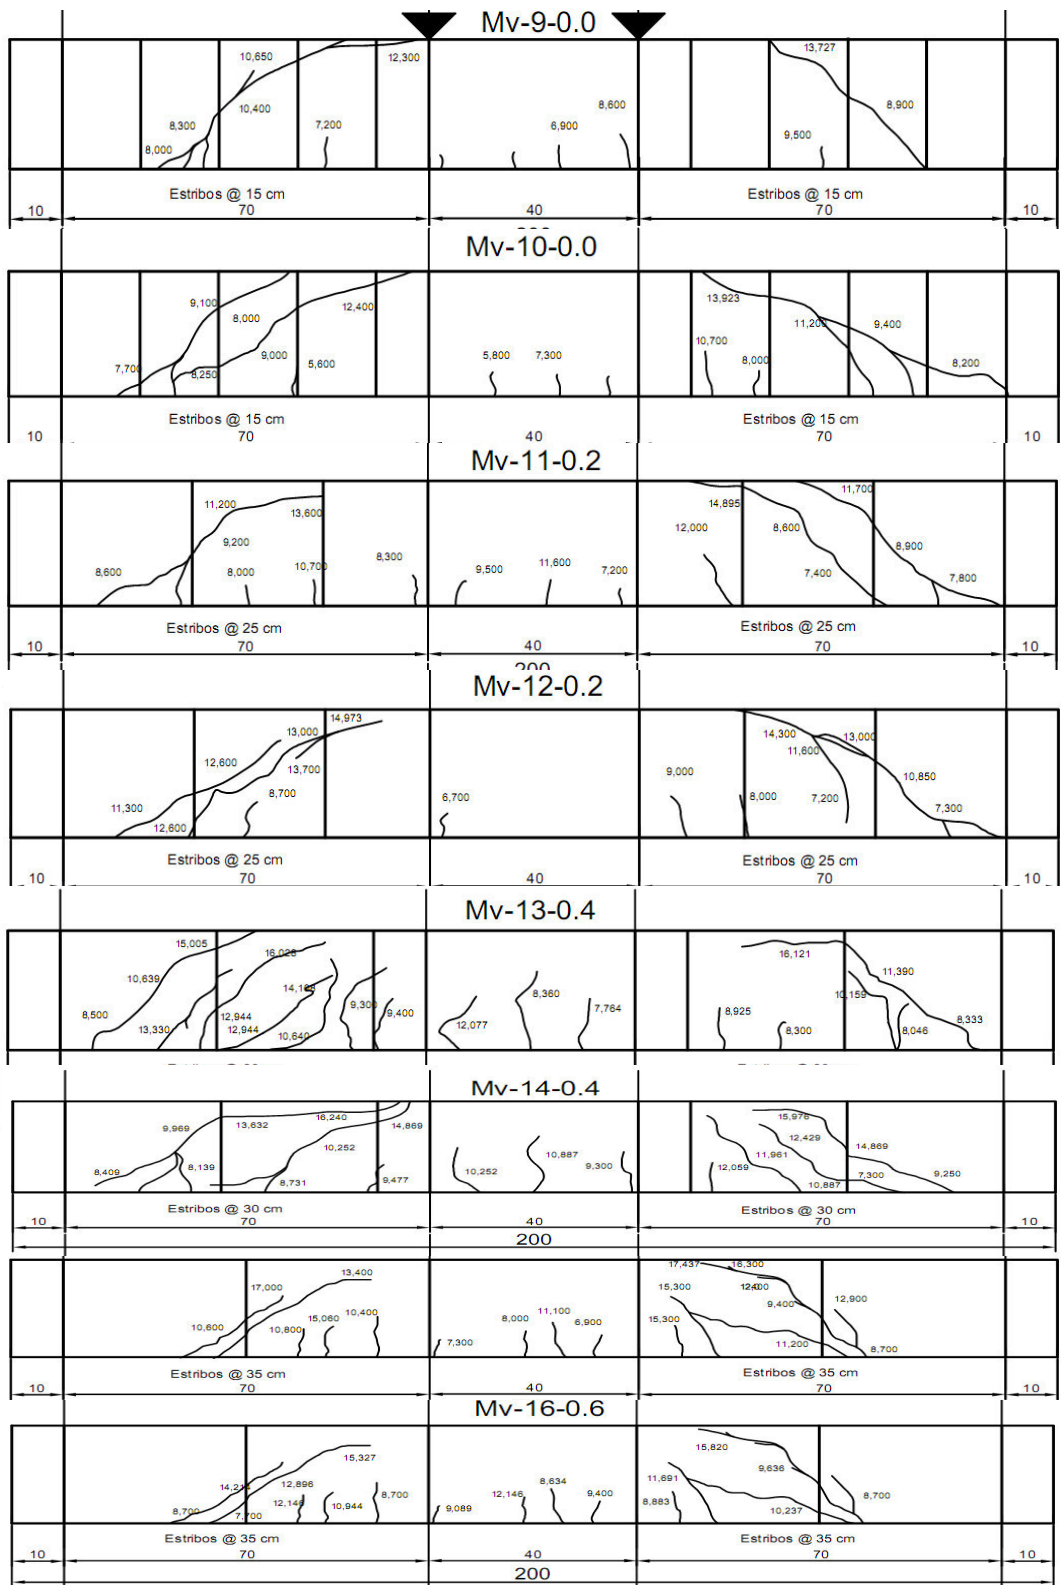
Patr3n de agrietamiento para las vigas reforzadas transversalmente con fibras y estribos para la relaci3n (a/c) 0.35.
